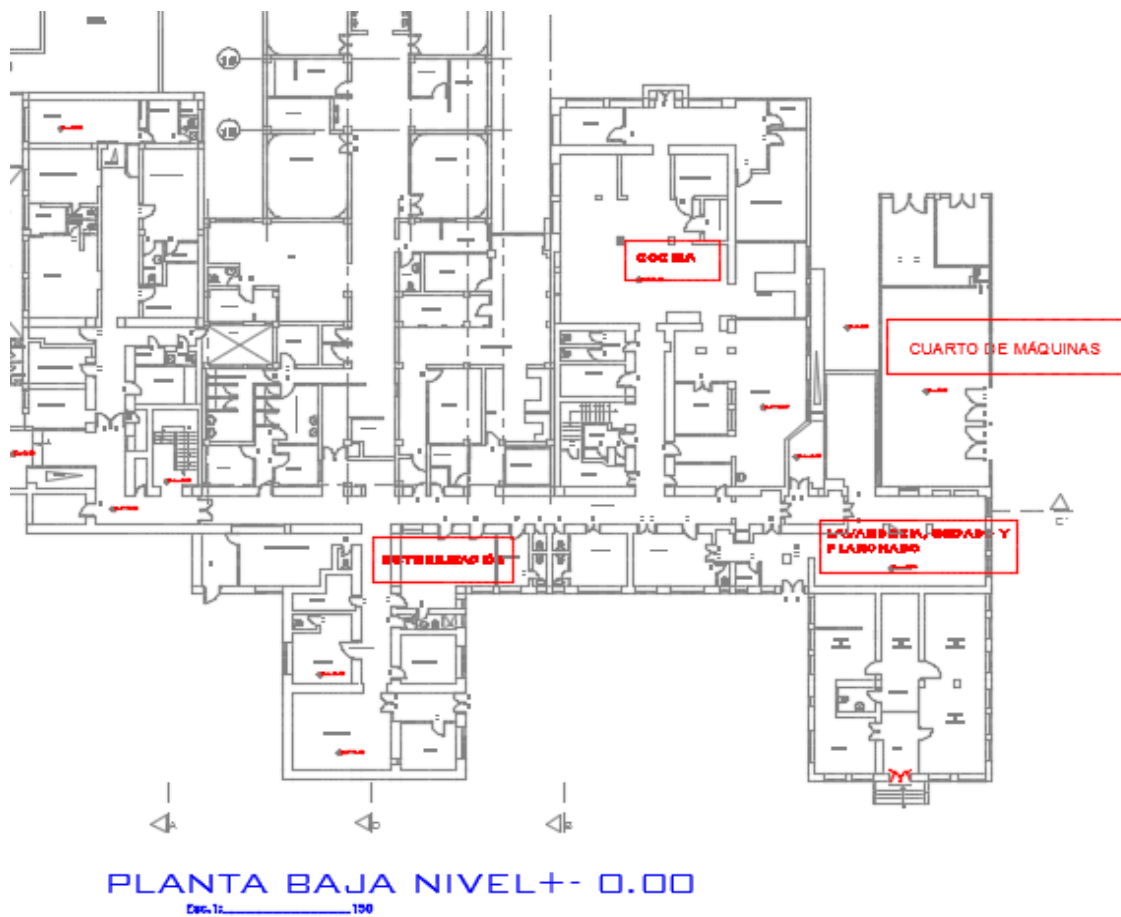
Áreas de Lavandería, Cocina, Esterilización y Casa se Maquinas. Planta baja
